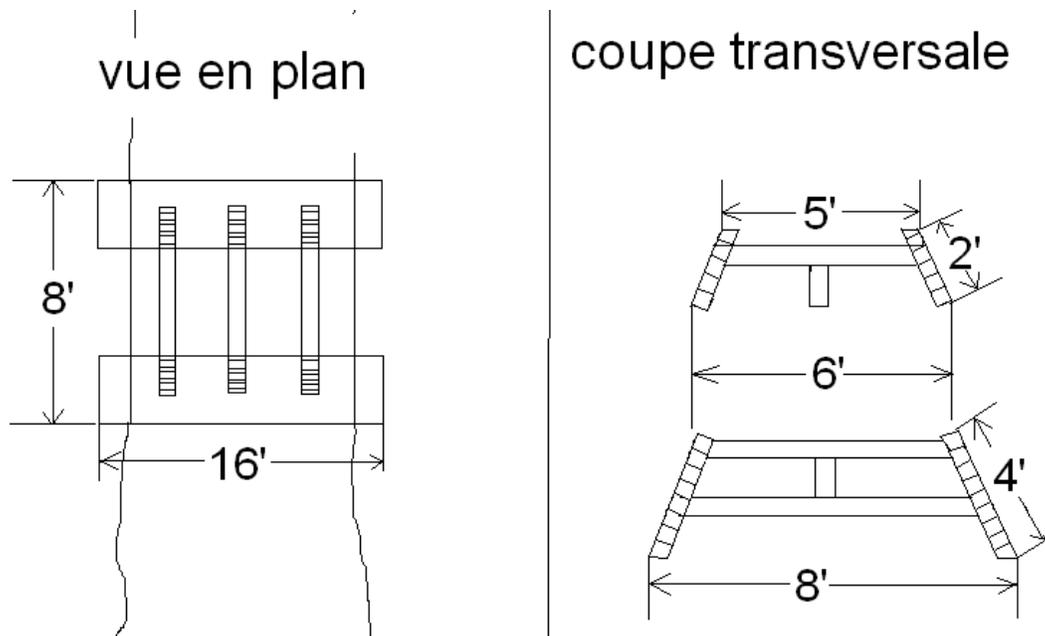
Plan de construction de la base du barrage double avec comblement (barrage 6) qui formera le dernier barrage du canal Beauharnois. La coupe transversale à droite représente les deux sections du barrage construites séparément et assemblées dans le canal.
